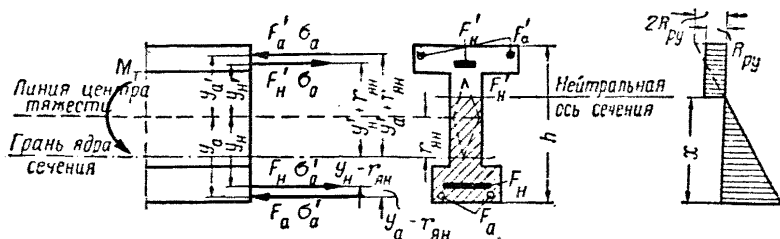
Схема распределения напряжений и усилий предварительно напряженного железобетонного изгибаемого элемента при расчете трещиностойкости зоны, содержащей арматуру F'_H и F'_a
